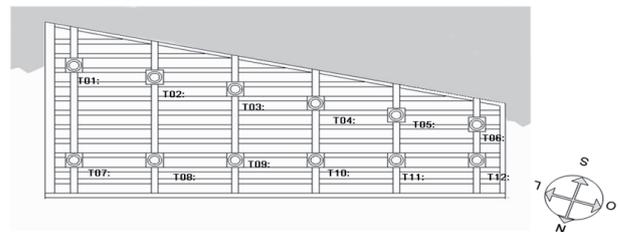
Croquis da estrutura elaborado para o levantamento.
